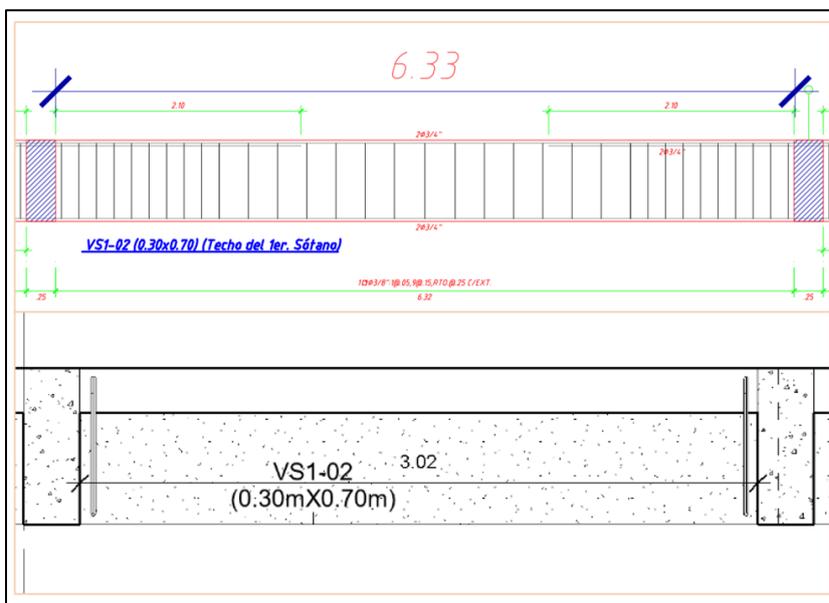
Viga VS1-02 dibujo en CAD y modelo en Revit
